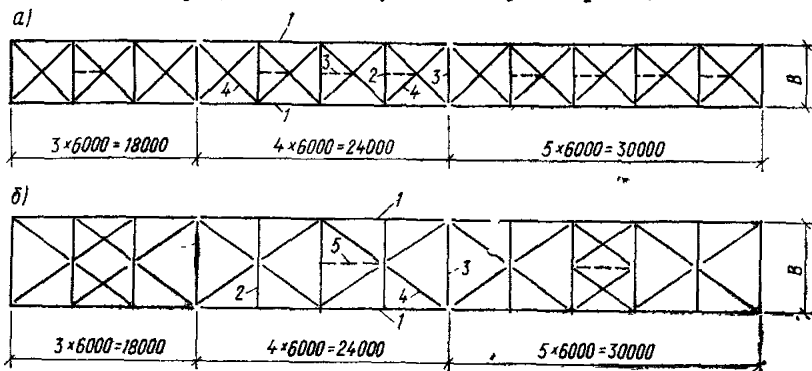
План балок и связей перекрытия для сборных железобетонных плит длиной 6 м
